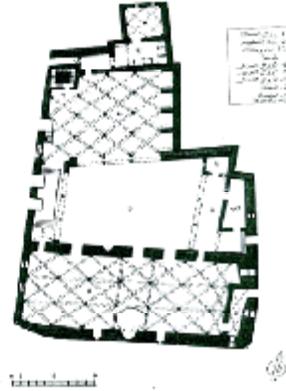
مسقط أفقي لجامع باب الأقباس بتونس، عن: Marçais, Ibid., fig.261, p.460.
